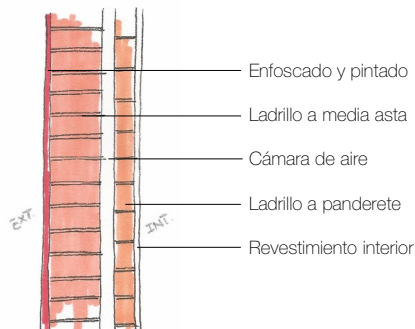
Sección de la pared Oeste (acceso), Sur y Este, muro medianero y cerramiento patios con acabado enfoscado (autoría propia).
